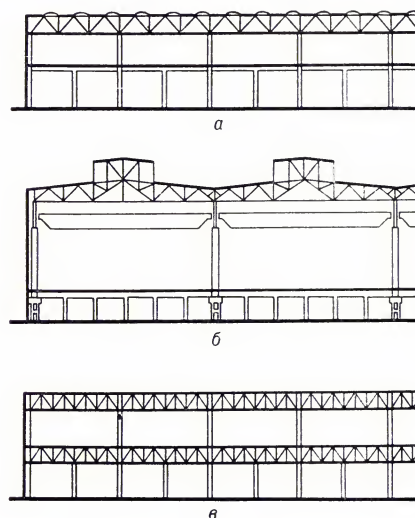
Двухэтажные промышленные здания: а — многопролётное здание со световыми фонарями и укрупнённой сеткой колонн в верхнем этаже; б — здание с нижним техническим этажом; в — здание с промежуточным техническим этажом.
